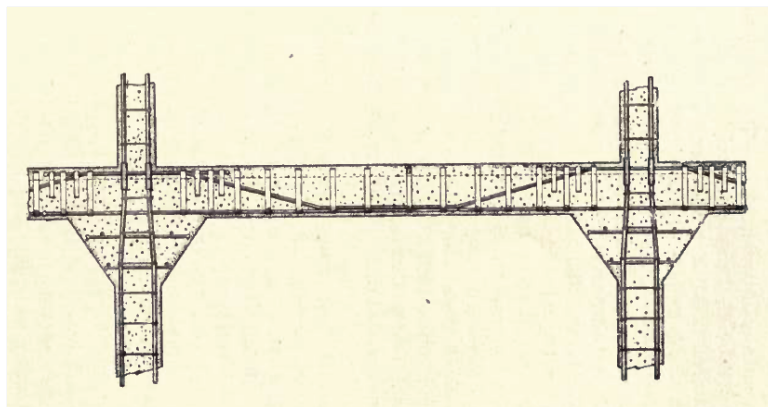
Disposizione tipica di armature di rinforzo per travi e pilastri (da Hennebique, 1894) - *Typical arrangement of reinforcement for beams and column (from Hennebique, 1894)
